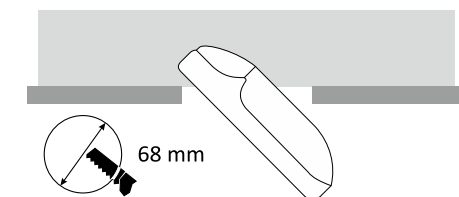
Installationsgehäuse für Decken- oder Hohlraumeinbau
